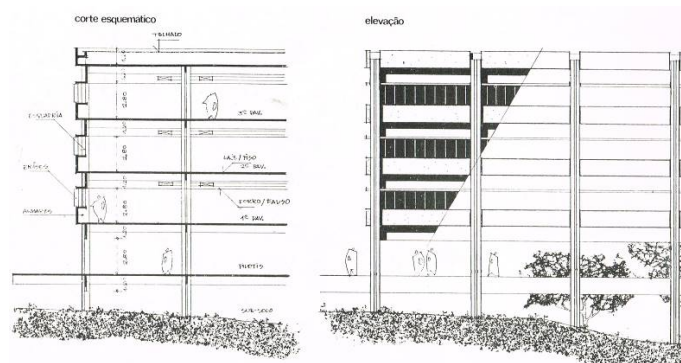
Corte e elevação da modulação da estrutura proposta para os edifícios do Plano Piloto
